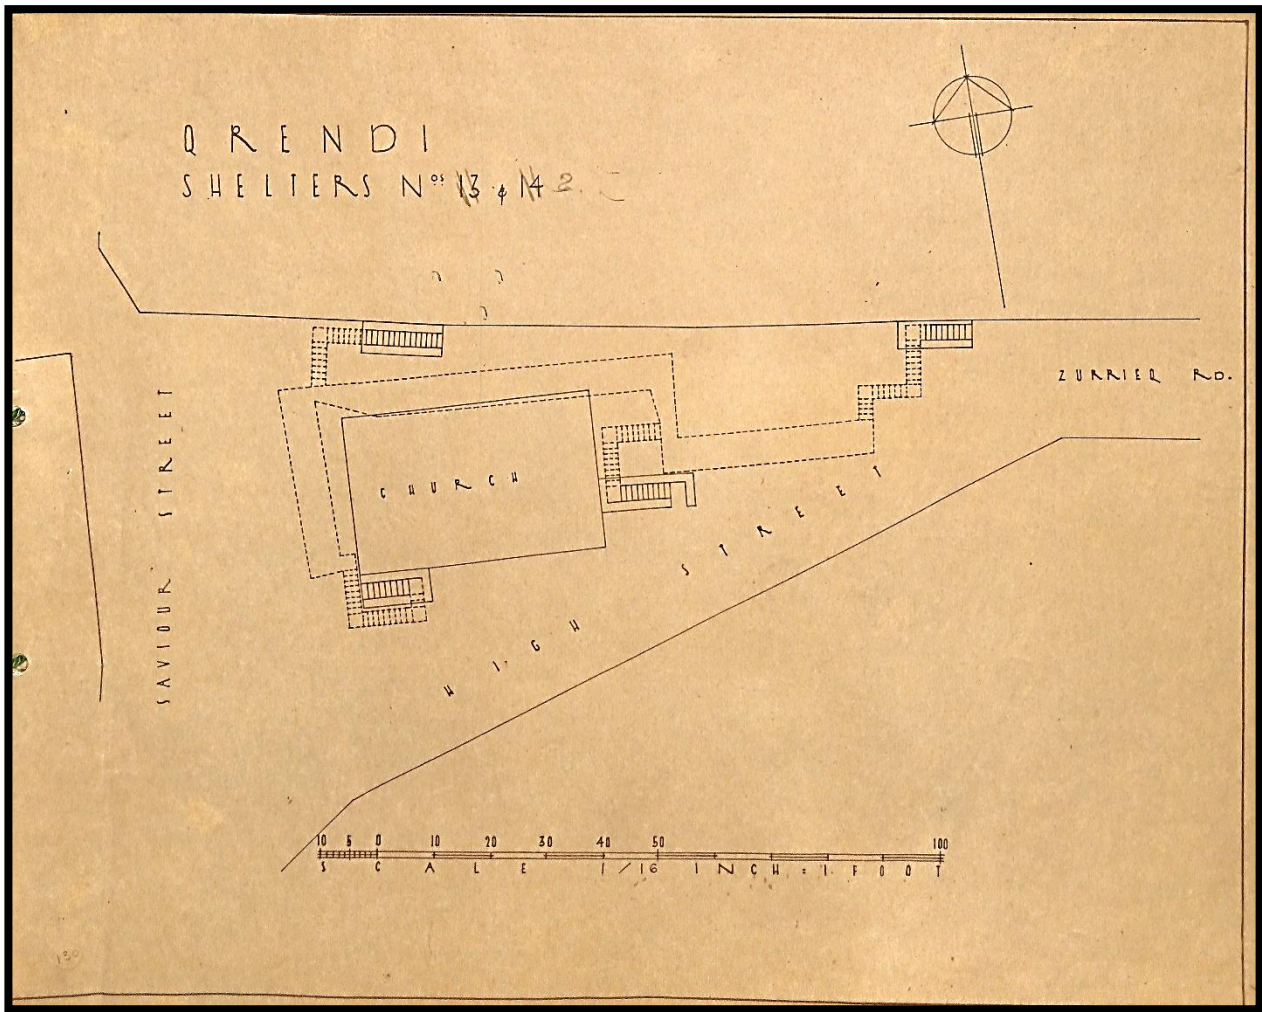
Planta do Abrigo nº2 "Saviour Street – High Street – Zurriq Ro."
